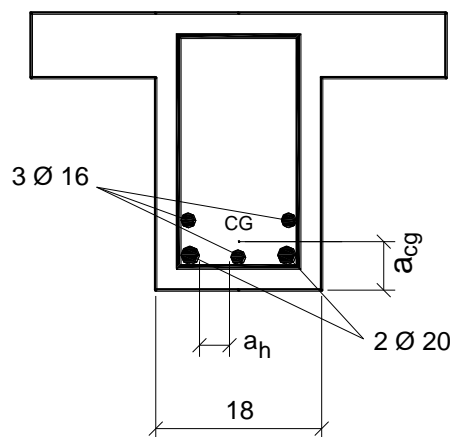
Detalhamento da armadura longitudinal na seção transversal.
